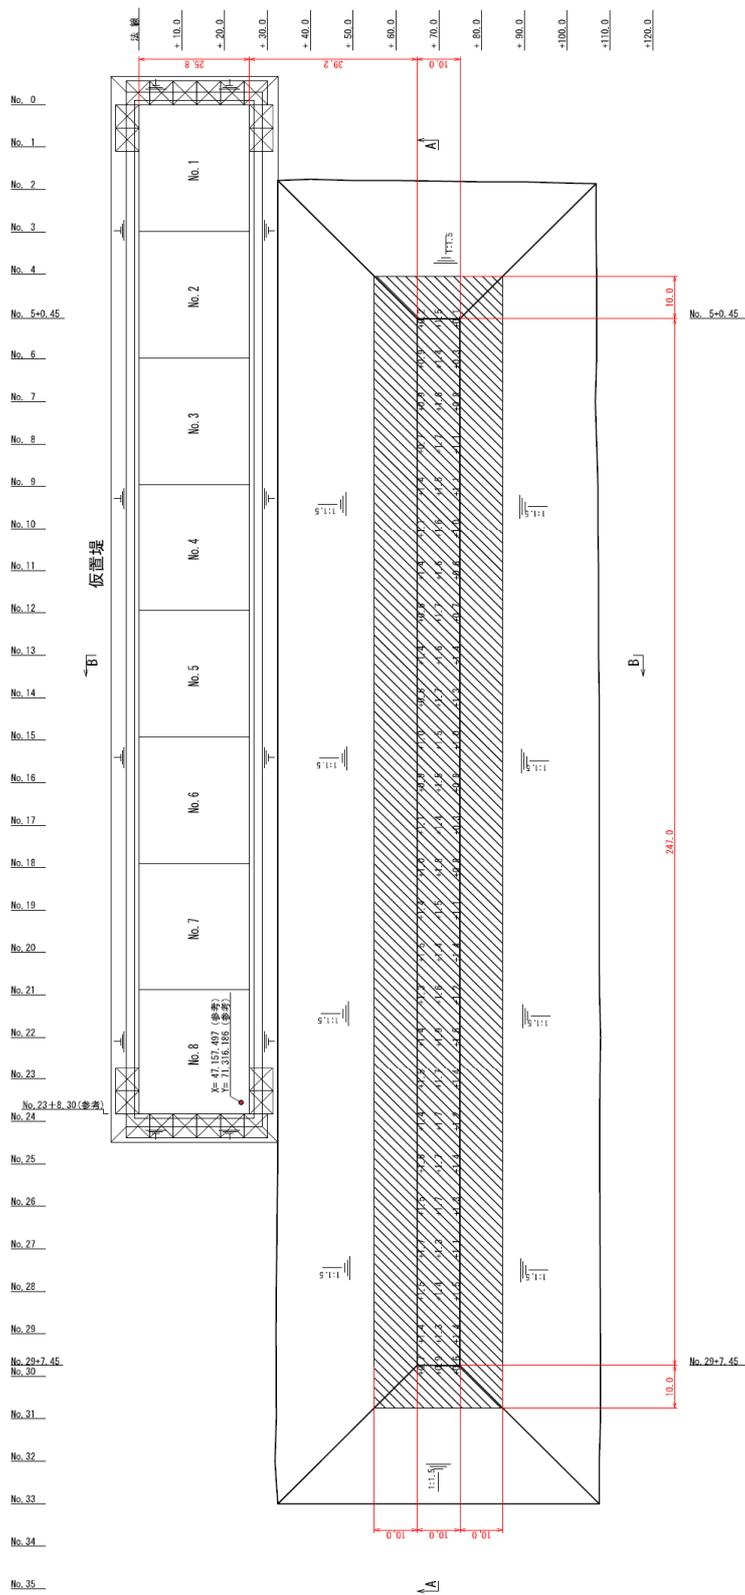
No.3 常陸那珂港区_東防波堤付帯工 (長周期波対策) 平面図 (被災後)
